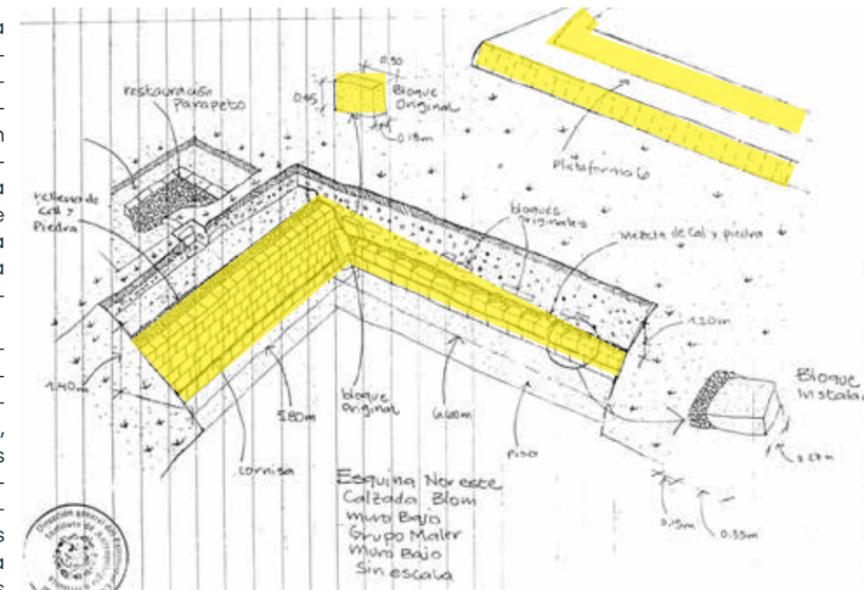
Dibujo Calzada Blom Esquina nor - este e la calzada y su contacto constructivo con la fachada sur de la plataforma sustentación del Grupo Maler. Descapote, integración de núcleo y sustitución en la fachada del primer cuerpo de la plataforma y calzada Blom. Dibujo: GAMH 2002
